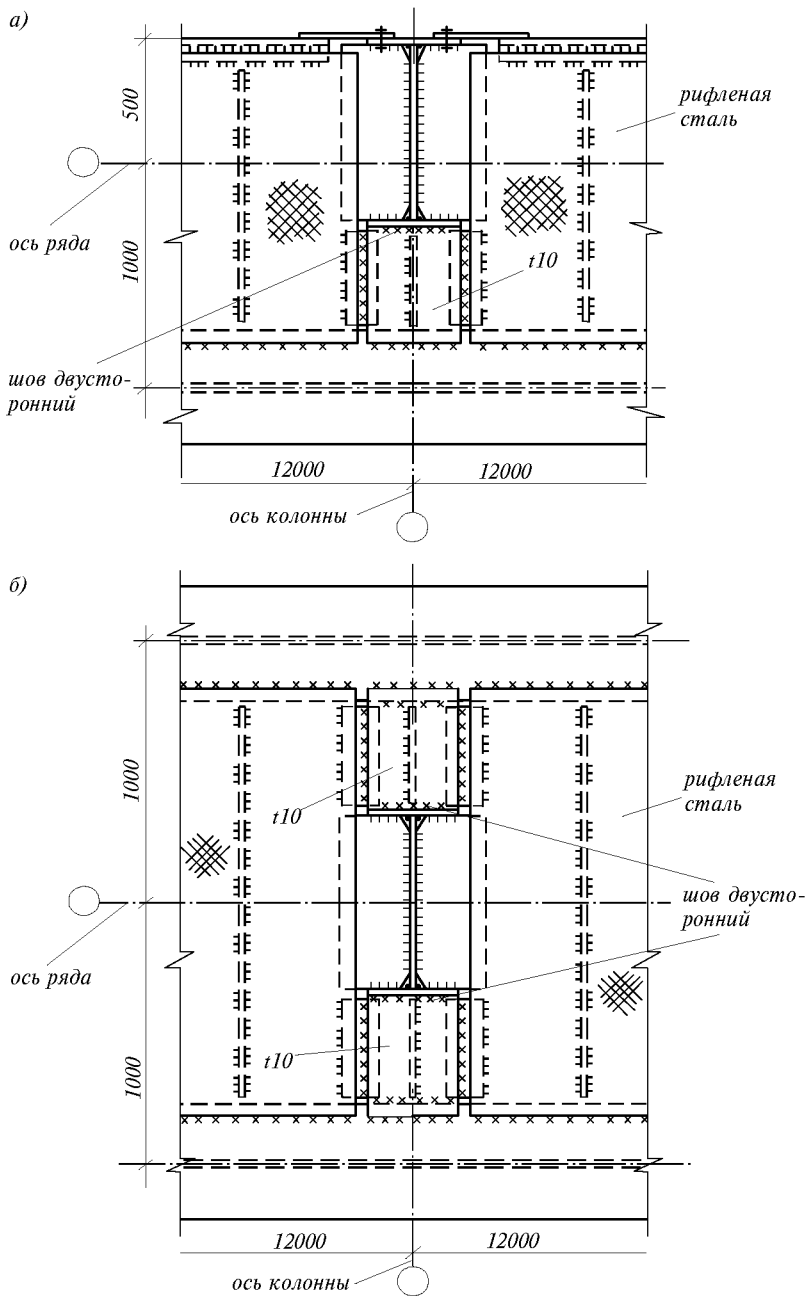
Сопряжение неразрезных подкрановых конструкций с колонной в уровне верхнего пояса
